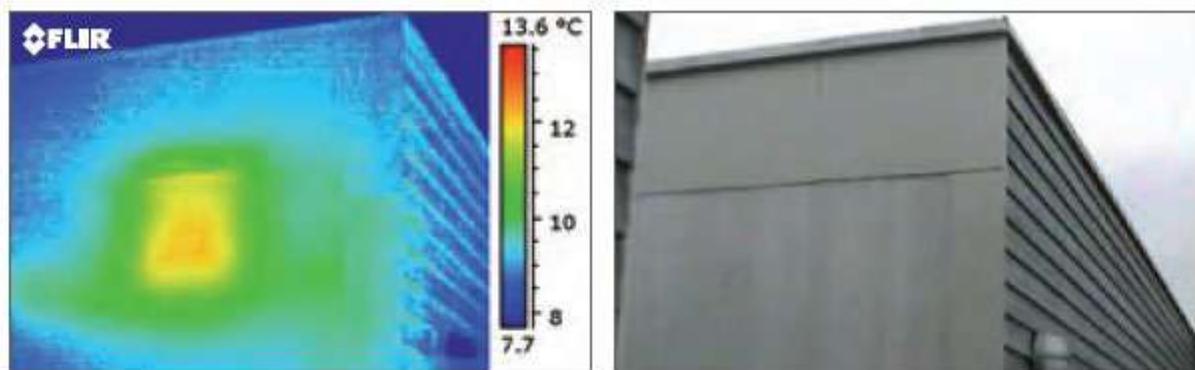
1: Falta de aislamiento en la fachada (FLIR Systems)
